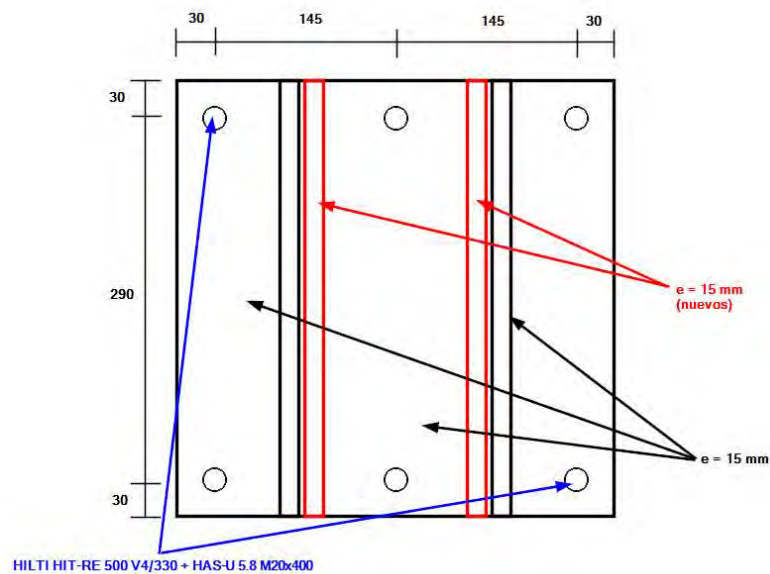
Esquema de refuerzo de placa existente con dos rigidizadores
